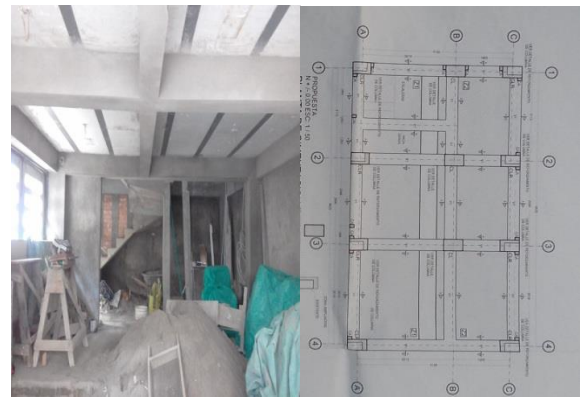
Faltante de las columnas B1, B2 y B3, fuente propia
